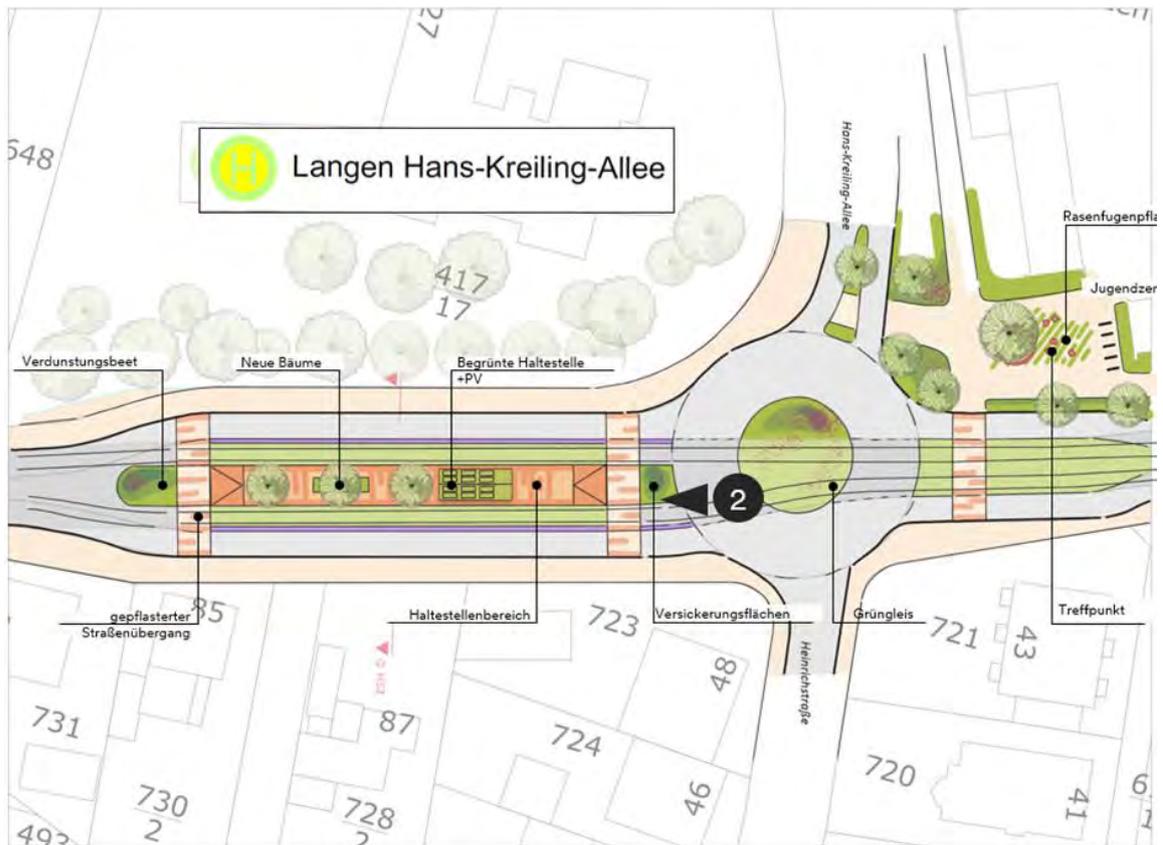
Lageplanskizze (Quelle Ramboll)
